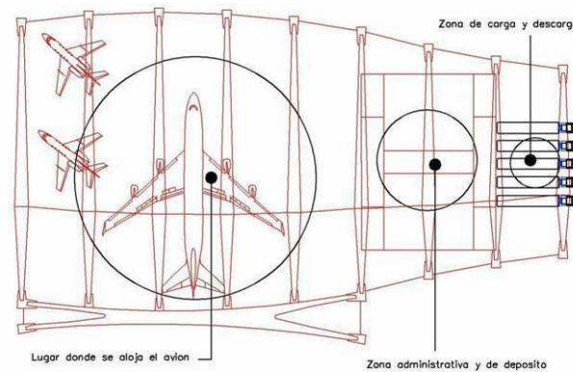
Hangar para Boeing 747. Planta de Arquitectura. Zonificación
